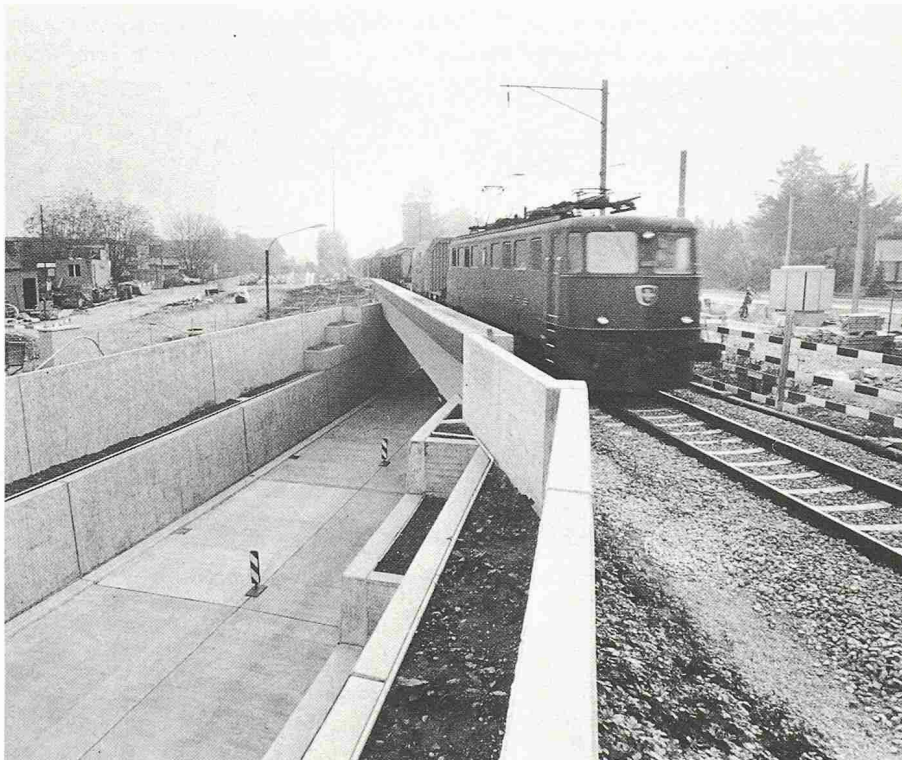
Unterführung im Betrieb. Am Bildrand rechts die separate Rad- und Fusswegunterführung. Foto D. J. Bänziger 13. 12. 86
